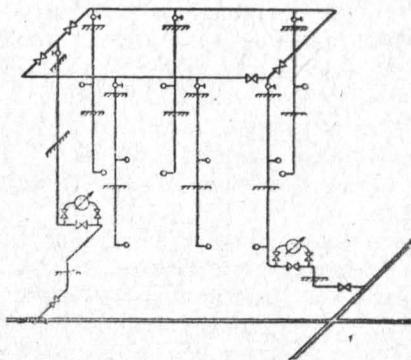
Схема внутренней водопроводной сети с верхней разводкой.
